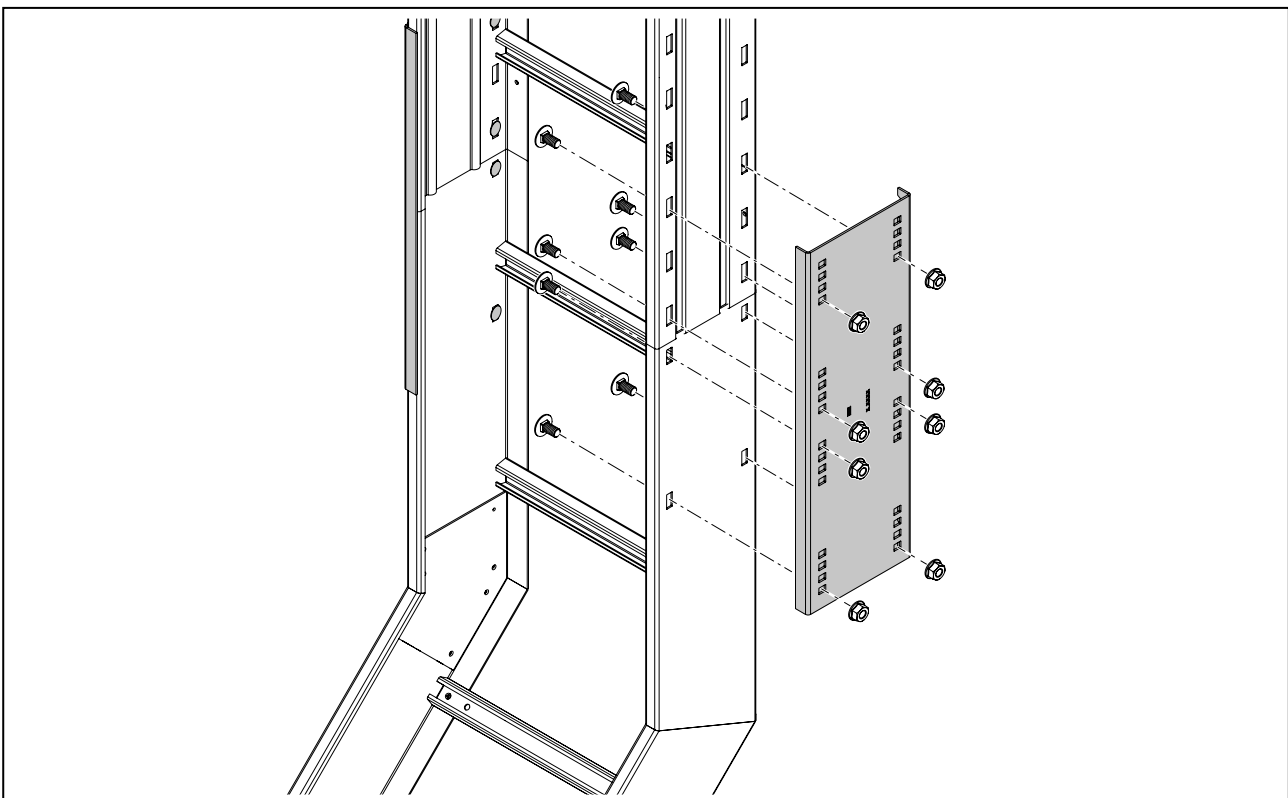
Längsverbinder WRVL horizontal anschrauben
